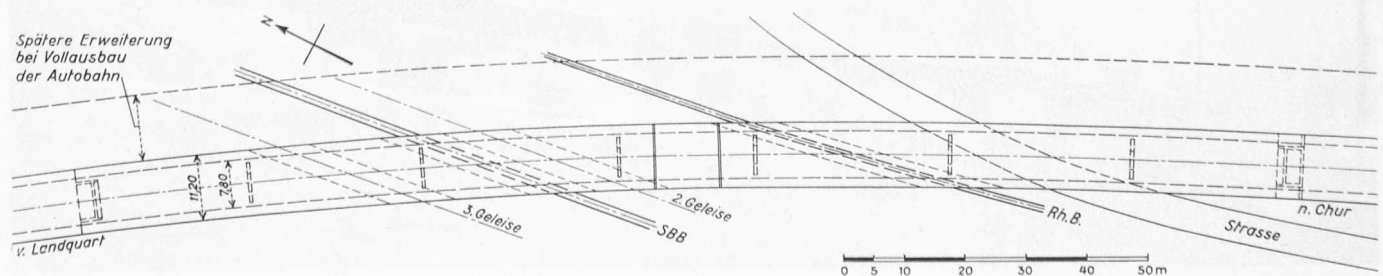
Ueberführungswerk Zizers, Grundriss 1:1250
